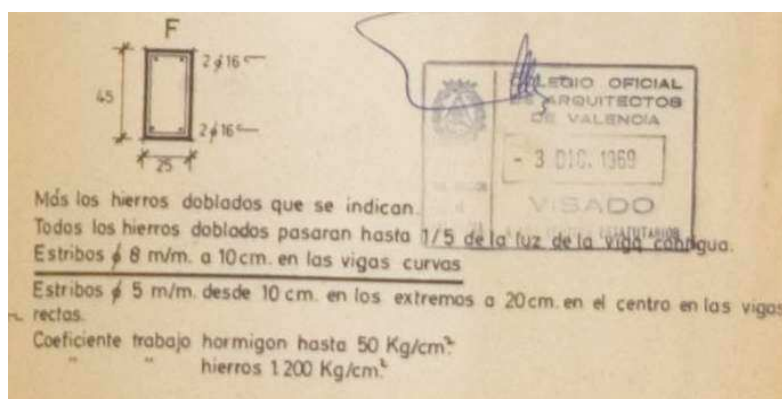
Leyenda del plano de vigas. Edificio ficha 207C.006, 1969.
